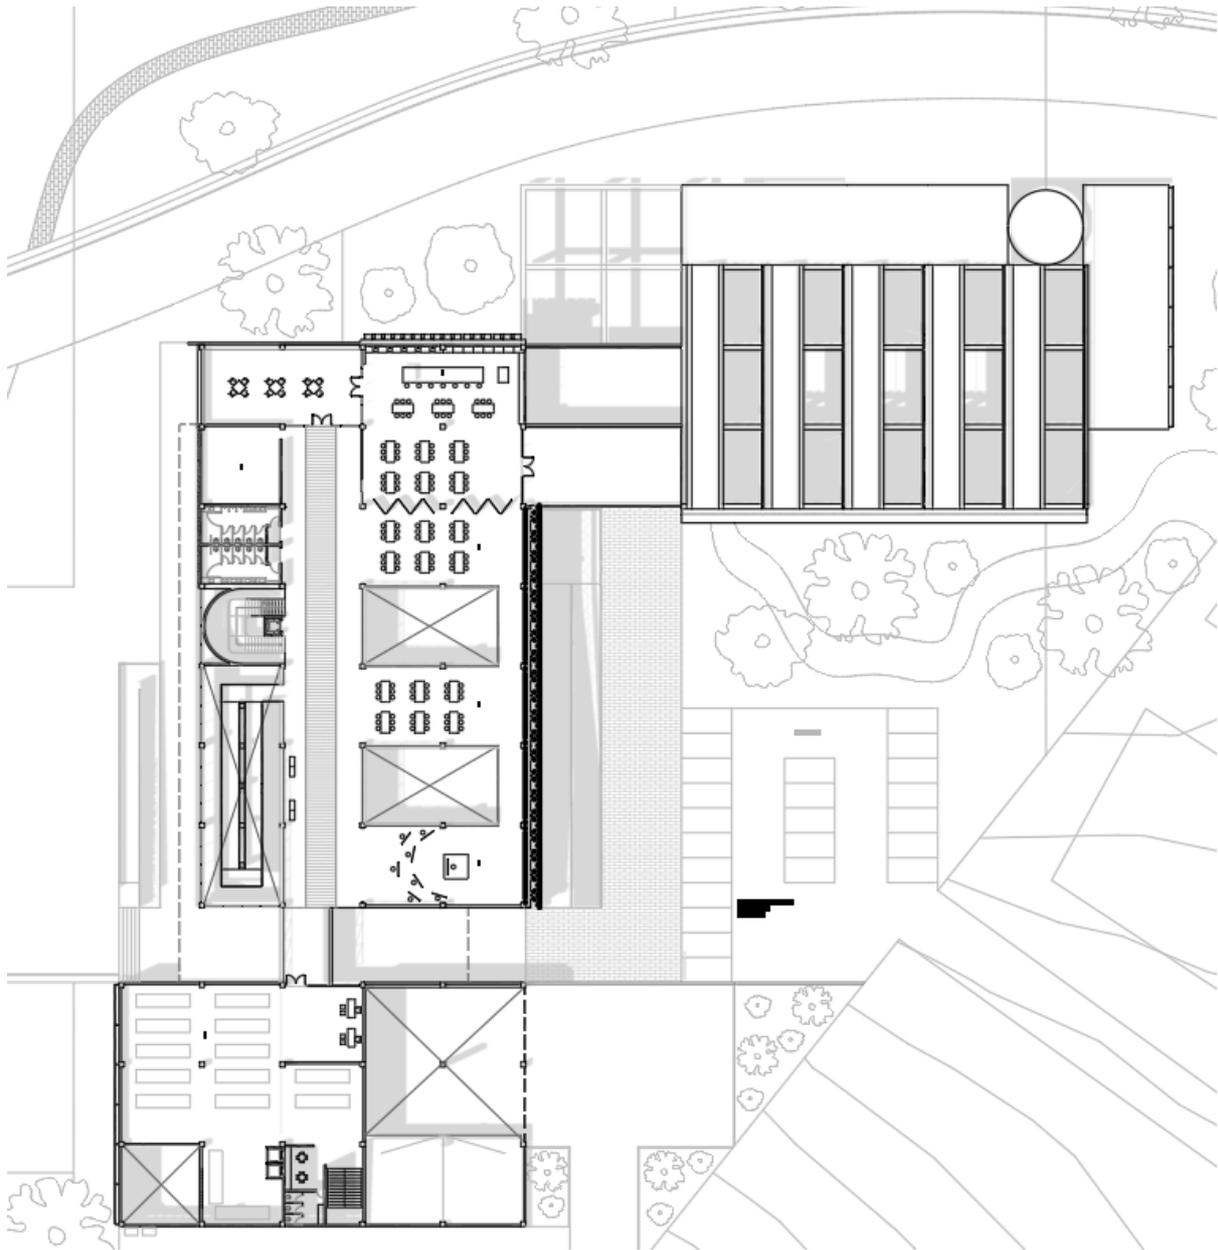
Planta baja nivel +5.00m. Elaboración propia
